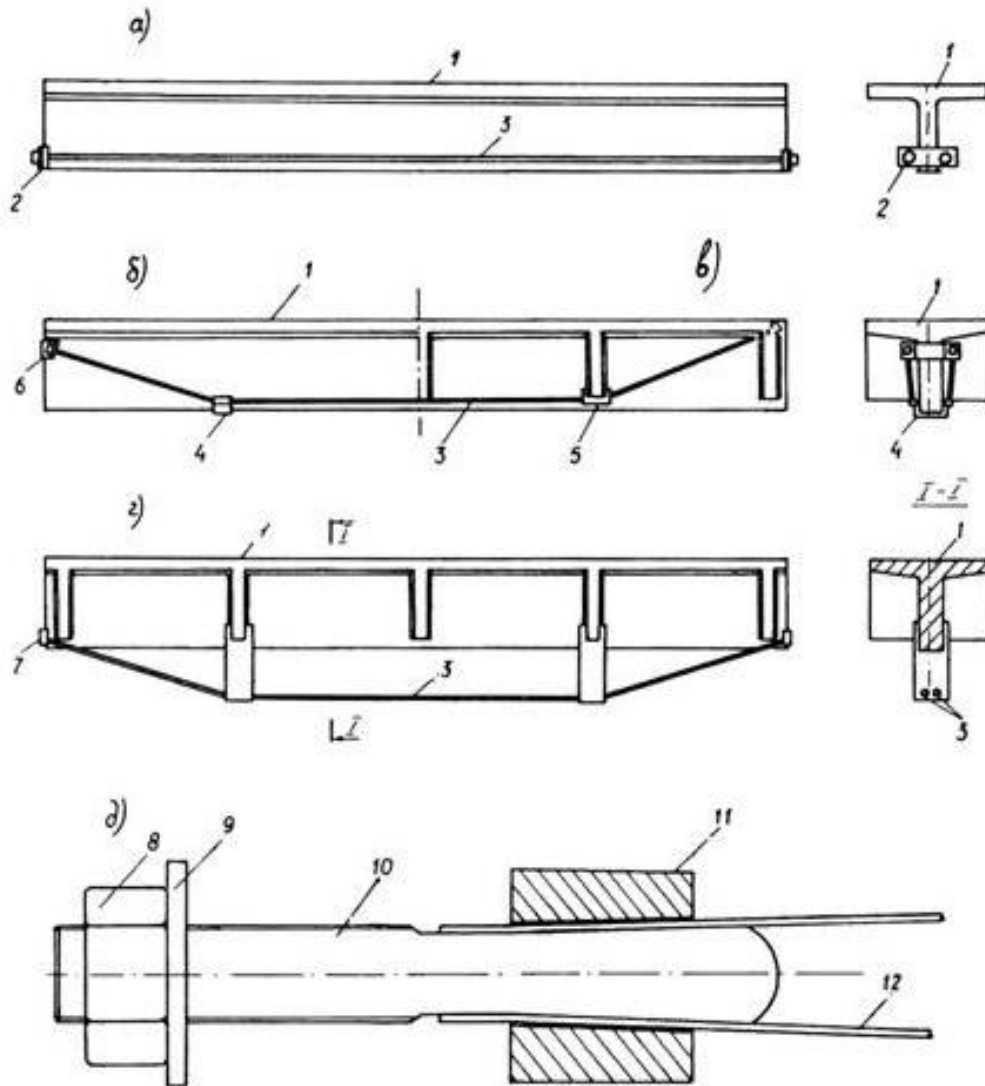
Схеми посилення залізобетонних балок високоміцною арматурою, що напружується (а, б – без діафрагм; в, г – з діафрагмами; д – за допомогою перехідного анкера); 1 – балка; 2, 6, 7 – анкерні вузли; 3 – затяжка, що напружується; 4, 5 – відтяжки; 8 – гайка; 9 – шайба; 10 – стрижень із високоміцної сталі діаметром 32 мм; 11 – конусна обойма; 12 – високоміцний дріт
